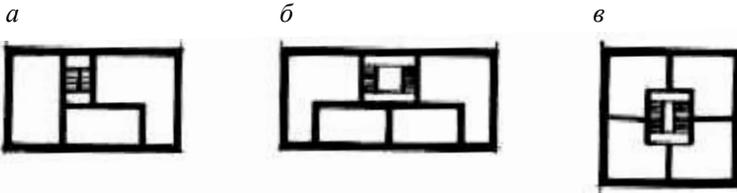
Размещение лестниц в секционных домах: а — у наружной стены; б — с расширенной этажной площадкой; в — в середине здания
